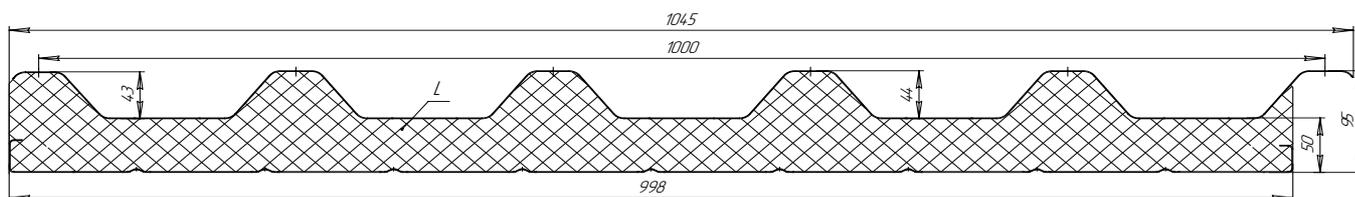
Панель трехслойная кровельная с монтажной шириной 1000 мм
